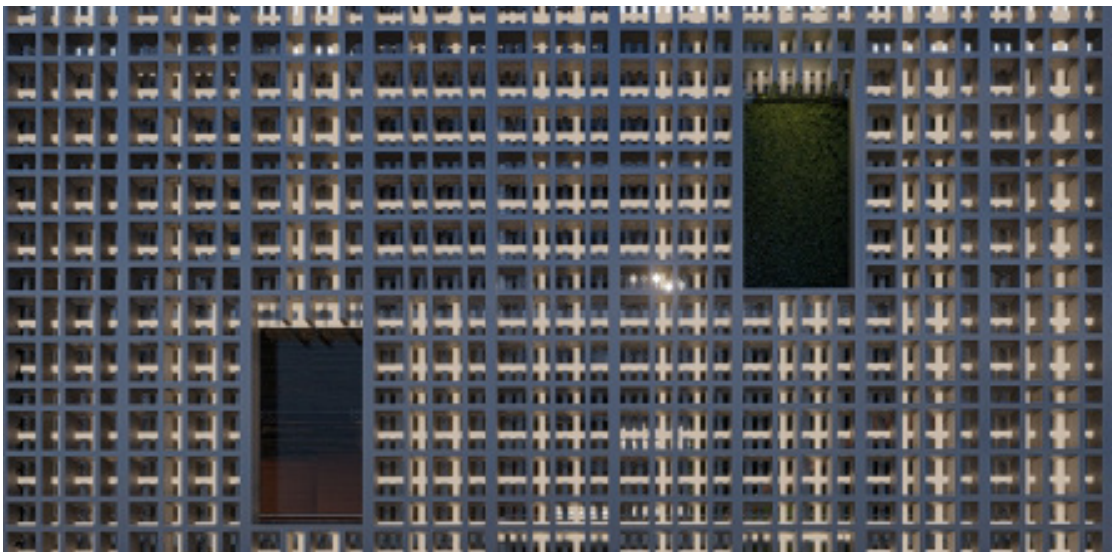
Detalhe da malha, na fachada oeste. Destaque para aberturas na fachada.
